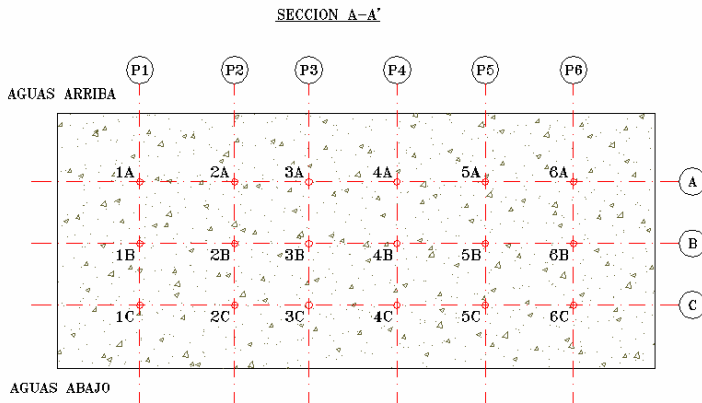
En planta se representa la proyección plana de la fisura y la intersección de cada taladro con ella.
